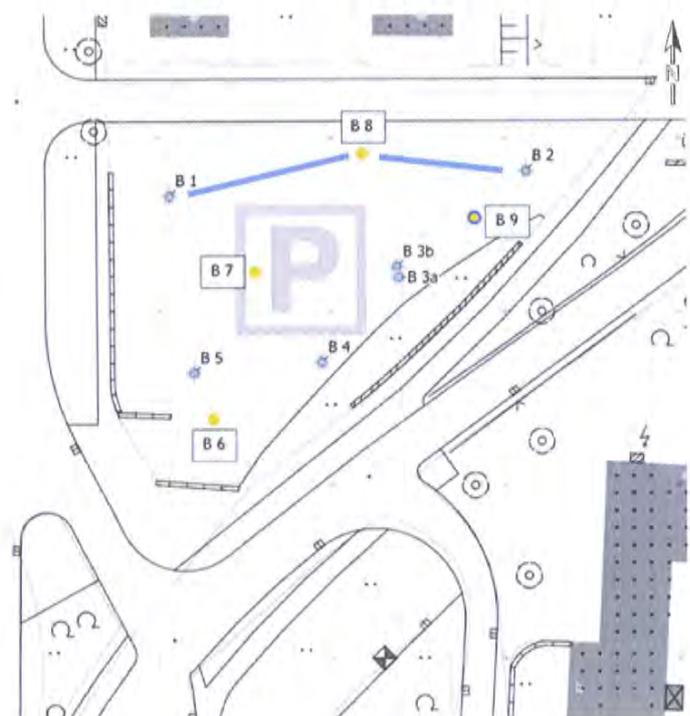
Bohrprofile und Lageplan der Bohransatzpunkte
